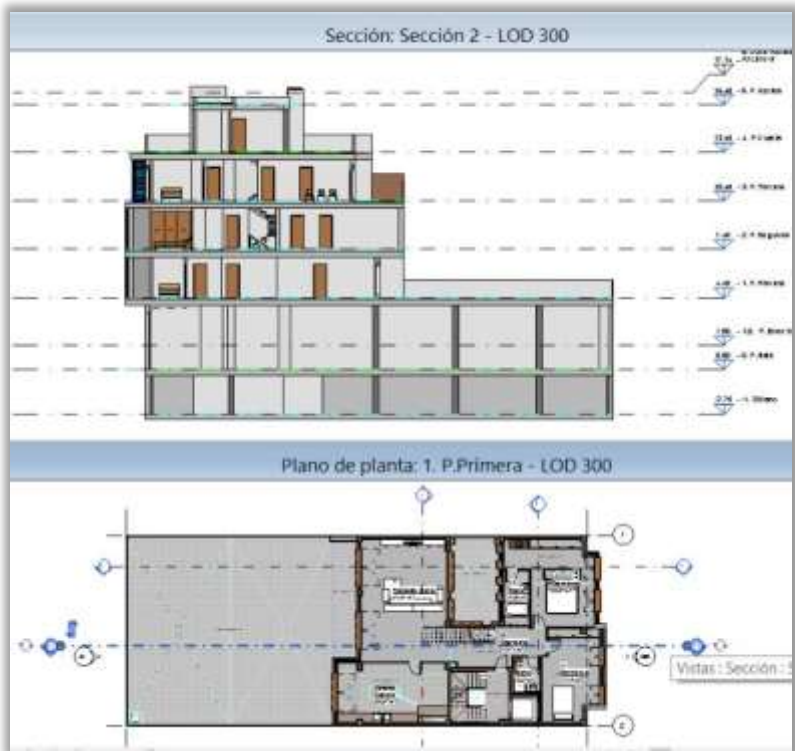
Detalle ejemplo trabajo desde tablas planificación
